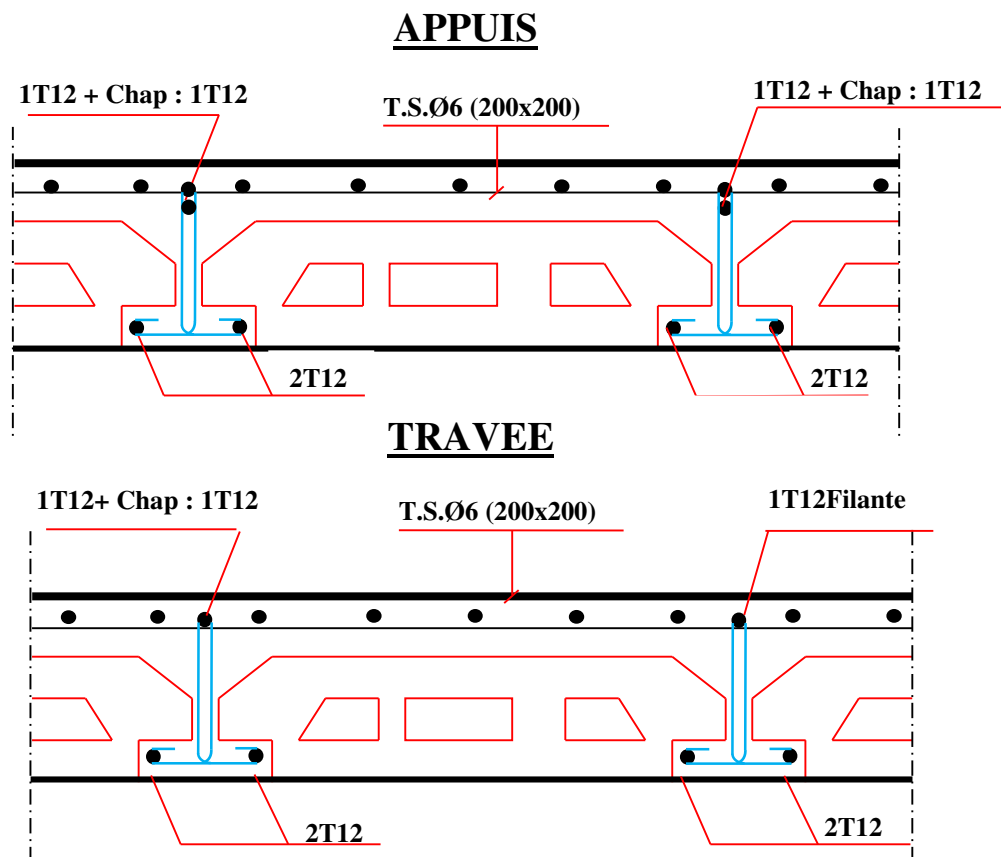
SCHEMA DE FERRAILLAGE DES POUTRELLES
